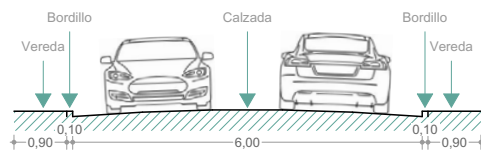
Calle Iván Orozco. Fuente: Autores.
